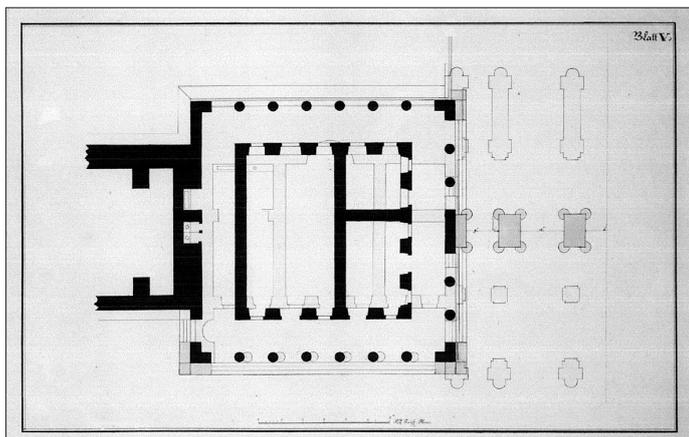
, Henrik von Nebbien, Äußeres Burgtor, Projekt 1820, Blatt V., Grundriss Detail, Albertina Wien
